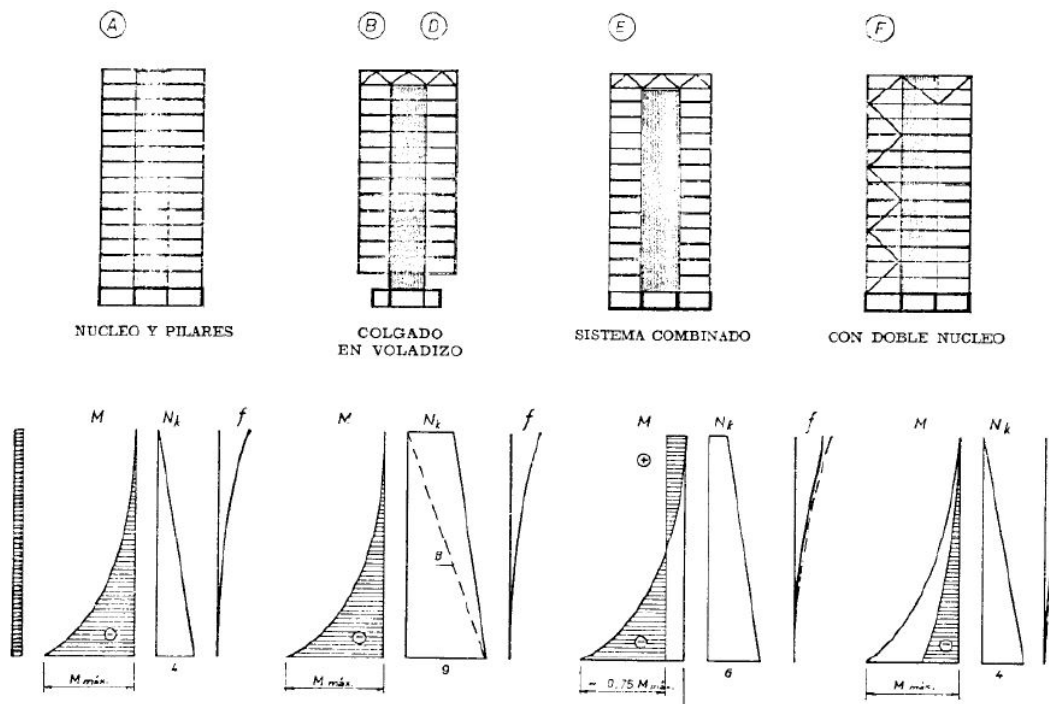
Reparto de la carga vertical entre elementos estructurales.
